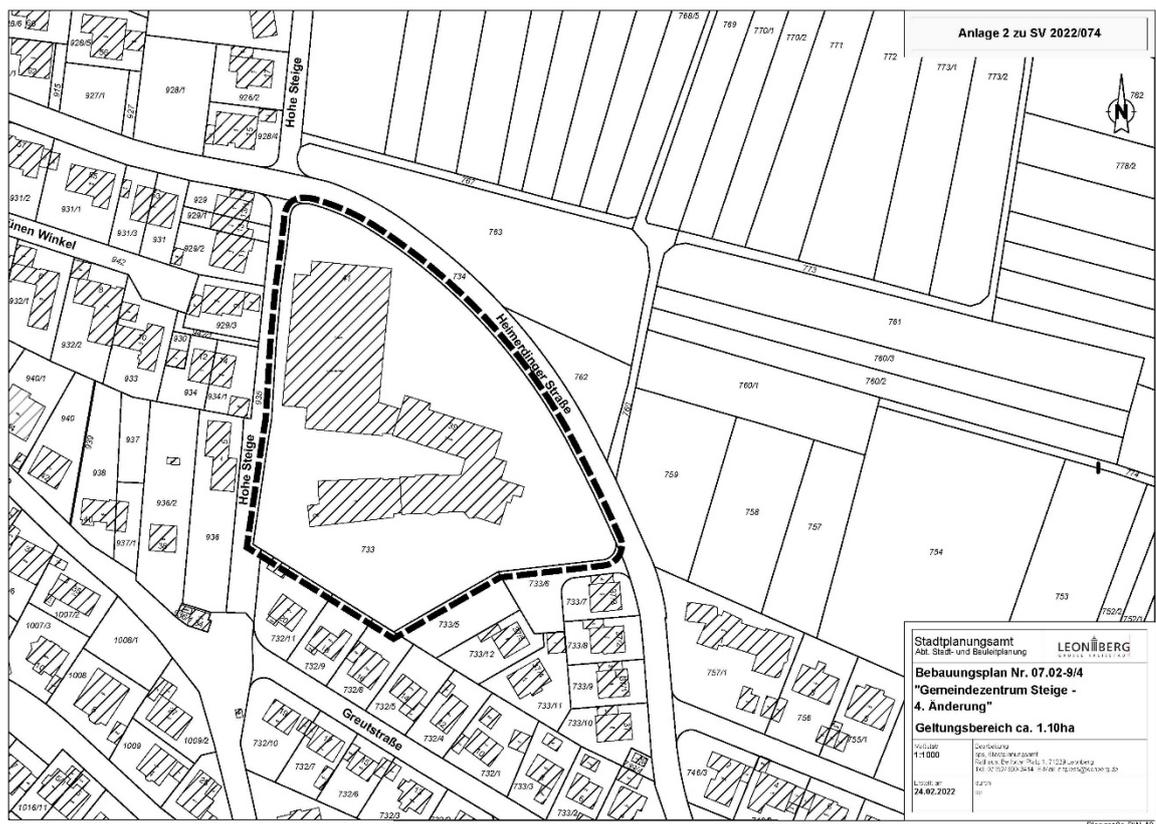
Geltungsbereich des Bebauungsplans, 1,10ha
